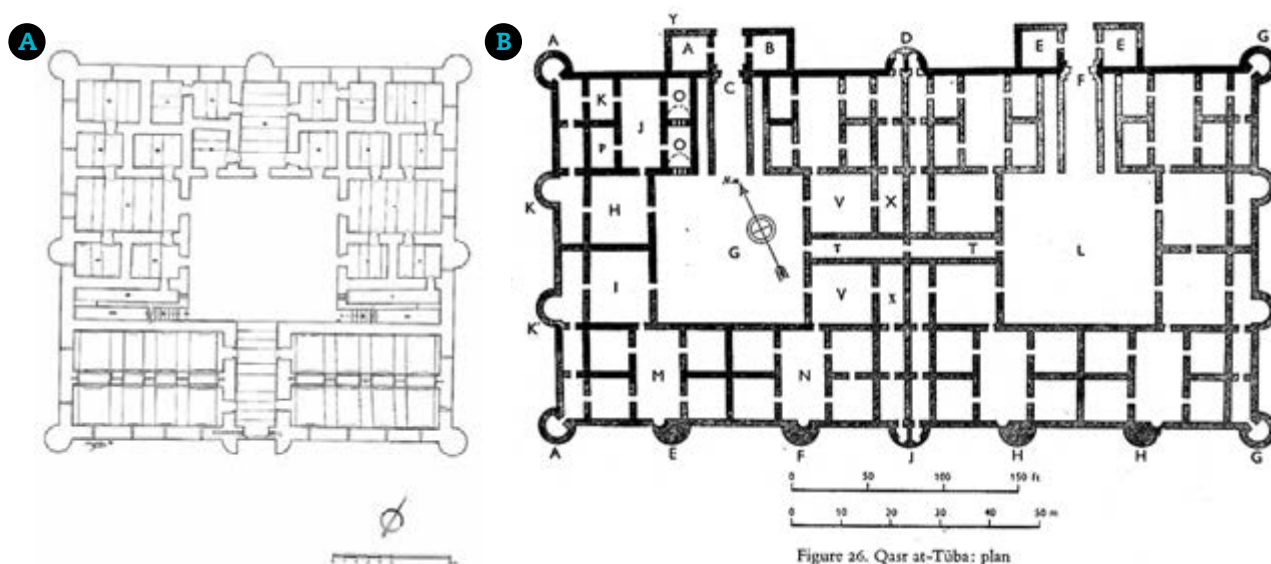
A. Planta baja de Qasr Kharana (según Urice 1989). B. Planta de Qasr al-Tuba (según Schlumberger 1986).
